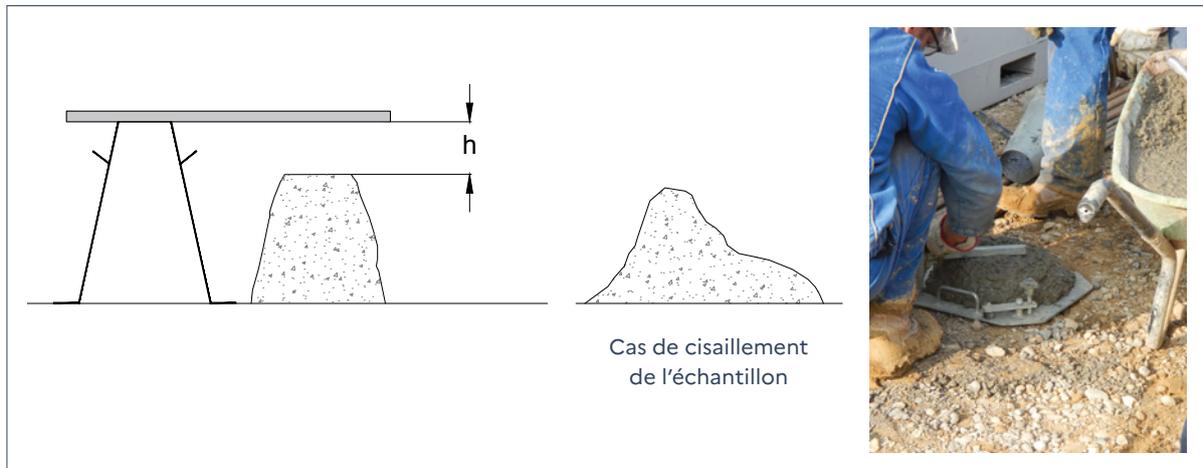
Essai d'affaissement (en cas de cisaillement de l'échantillon, l'essai doit être refait)
